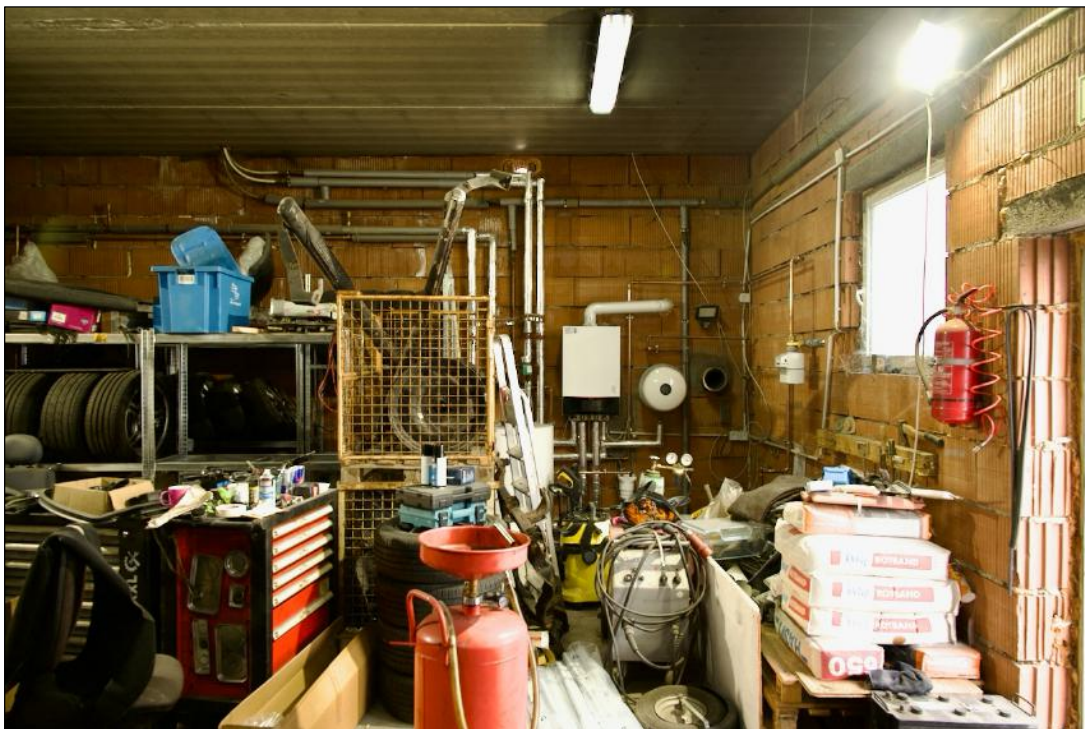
Lagerhalle mit Büro - Erdgeschoss
